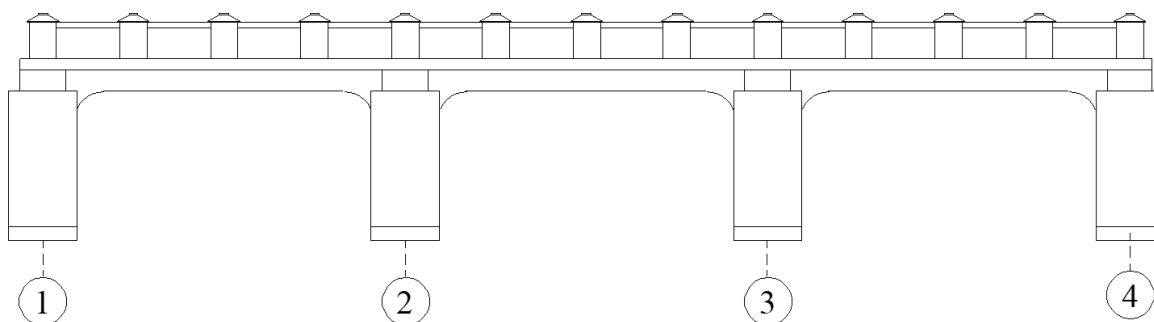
Estructuración transversal del puente. 01 losa sobre vigas.
